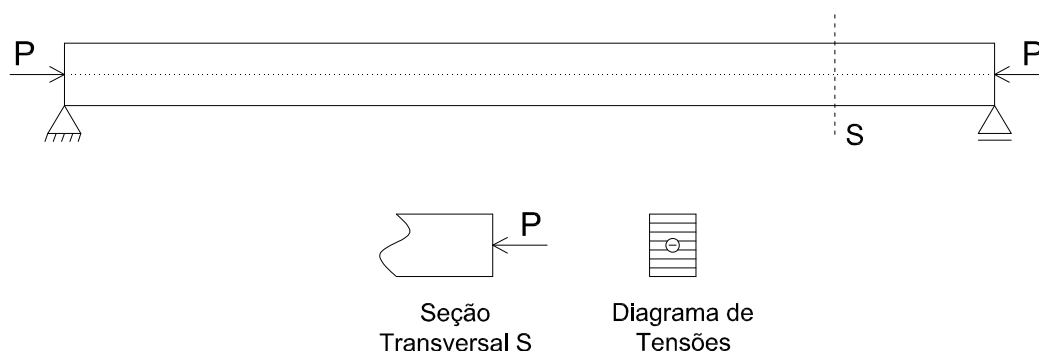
Viga isostática submetida à protensão centrada.
